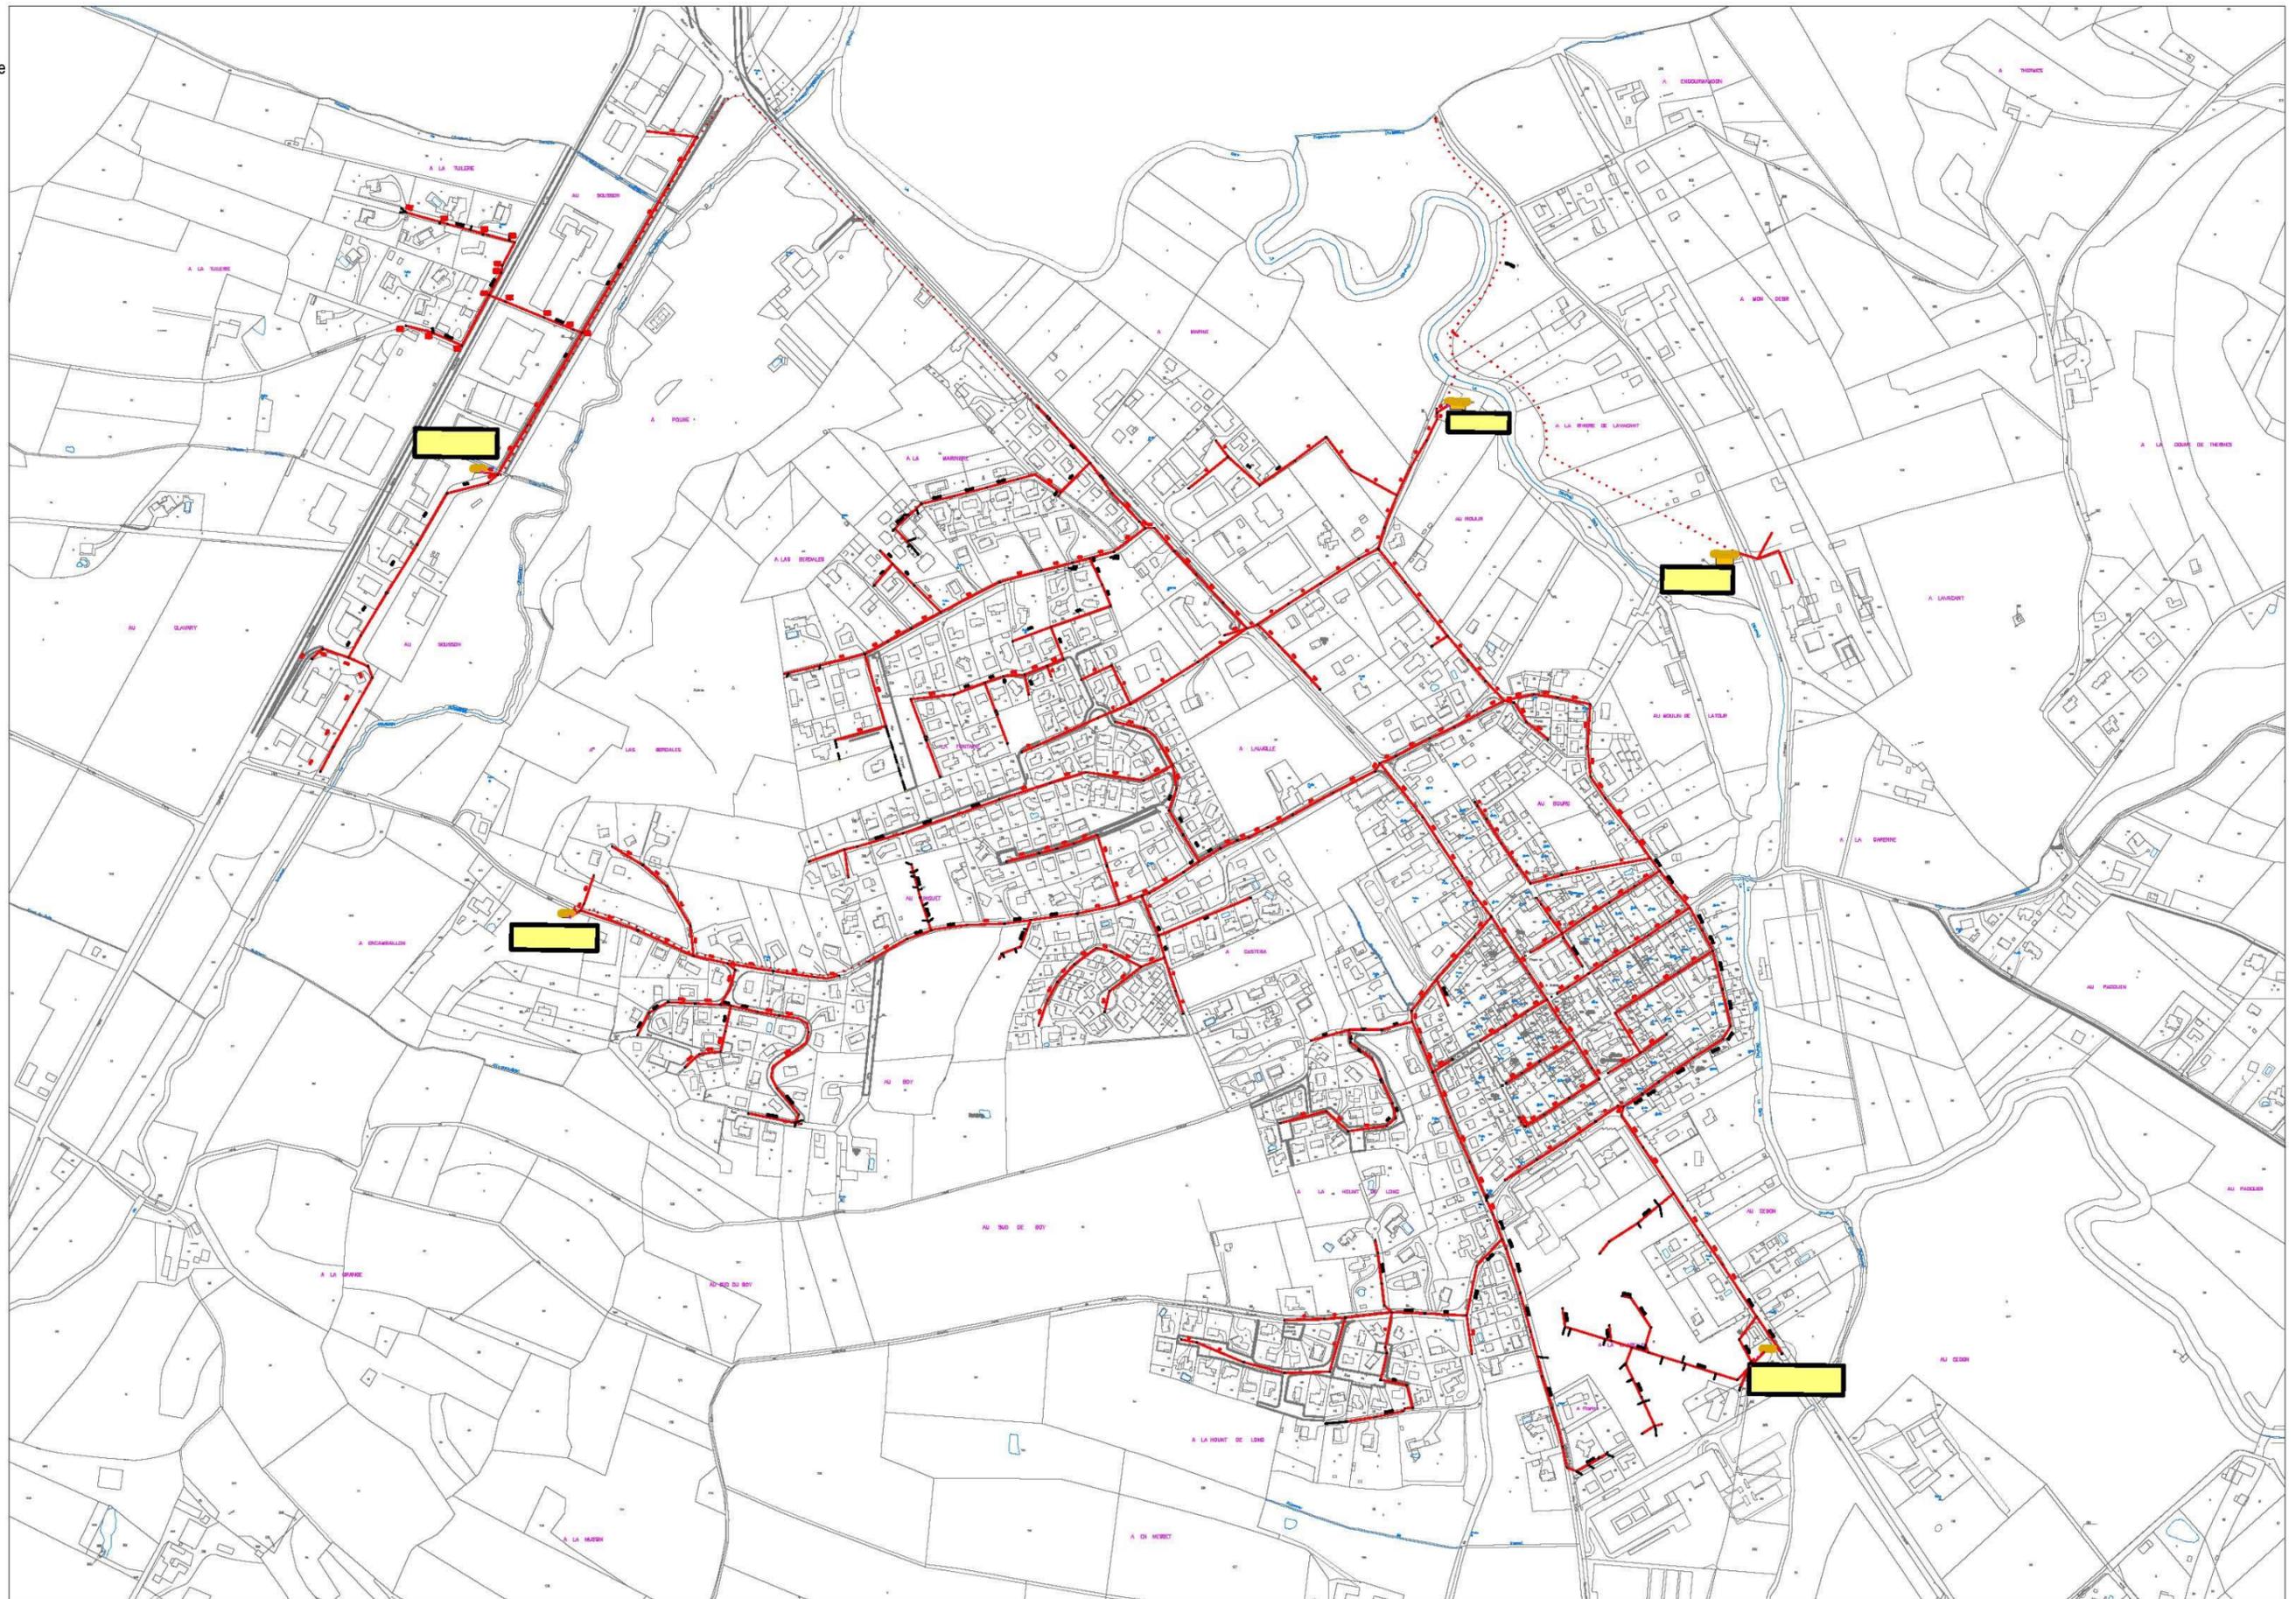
Plan du réseau d'eaux usées de la commune de Pavie
